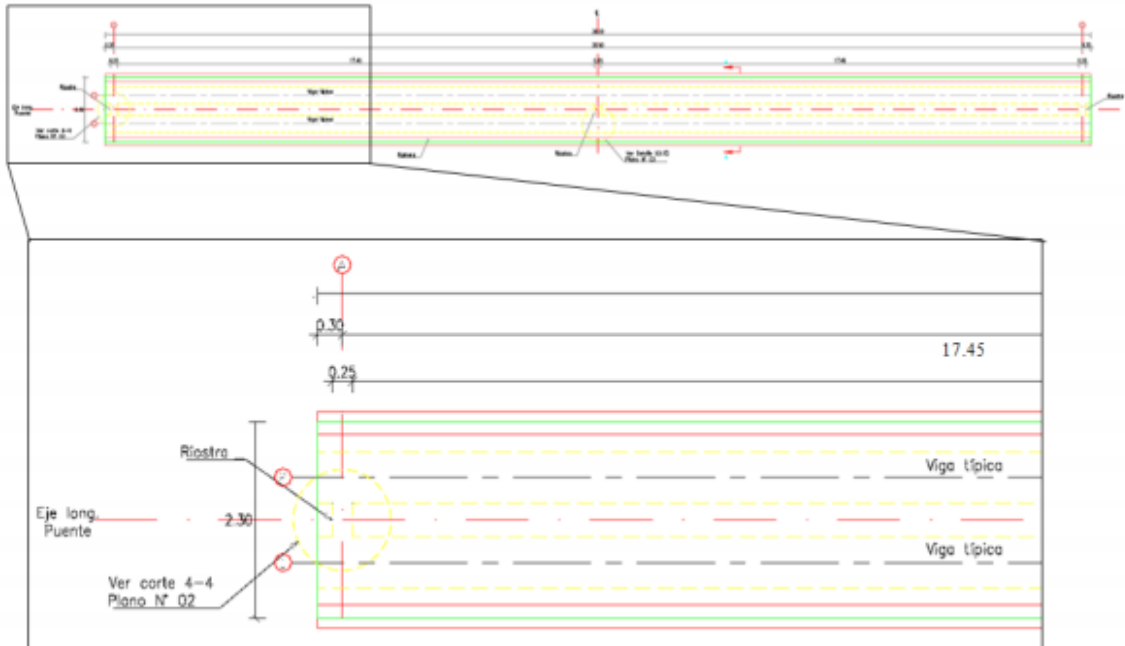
Plano Planta puente peatonal – Canal Torca con Avenida Calle 183.
